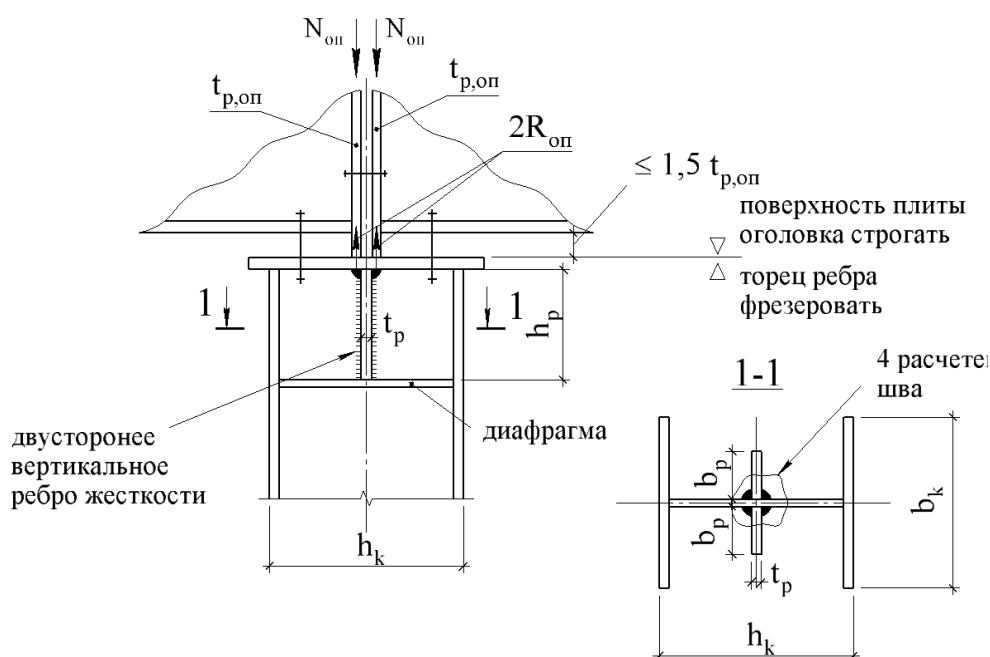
Шарнирное опирание на оголовок колонны балок с торцевыми опорными ребрами сверху
